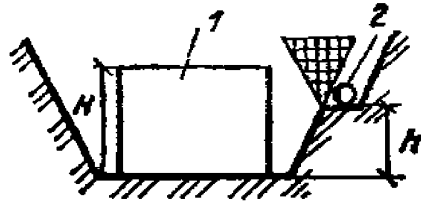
Прокладка трубопровода (2) вдоль здания (1)
